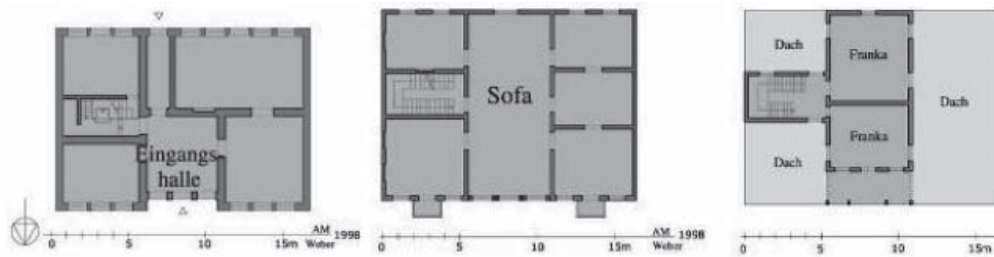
Bayt Gabri, Grundrisse EG, OG, DG
